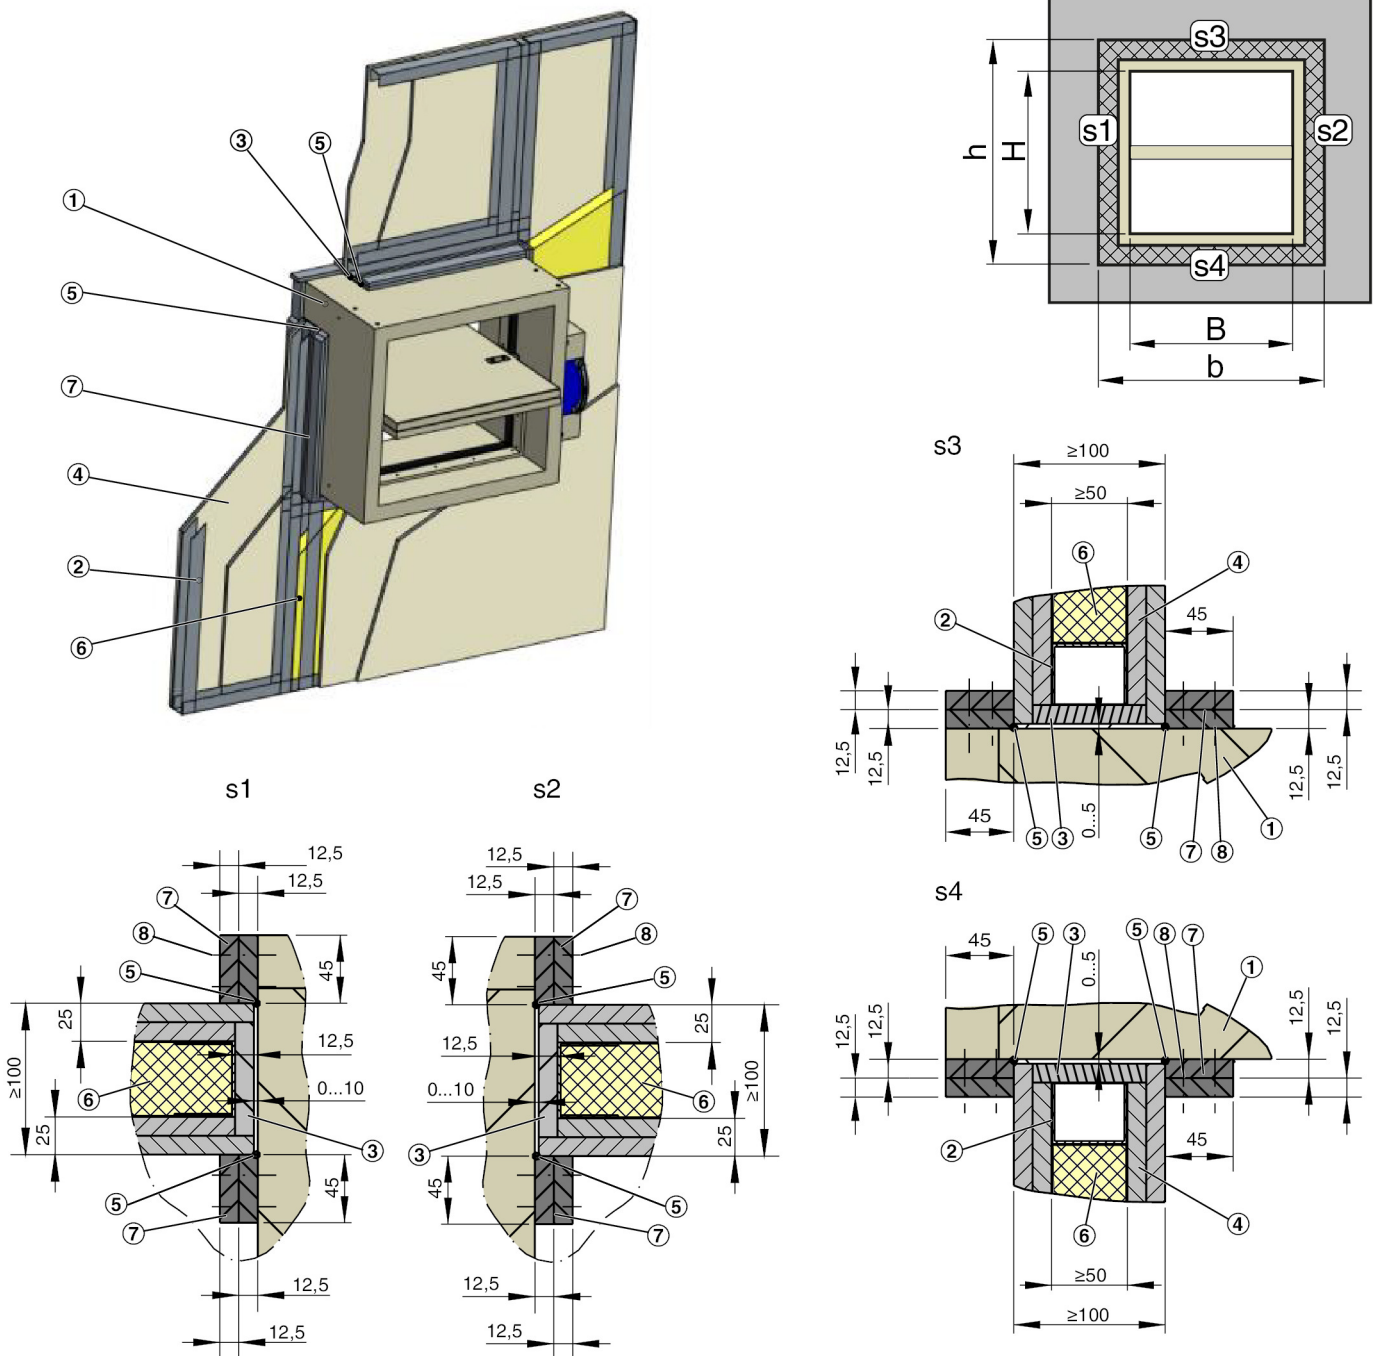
Trockeneinbau in Leichtbauwand, Einbauvariante b, Klassifizierungsindex: v_{ew}
